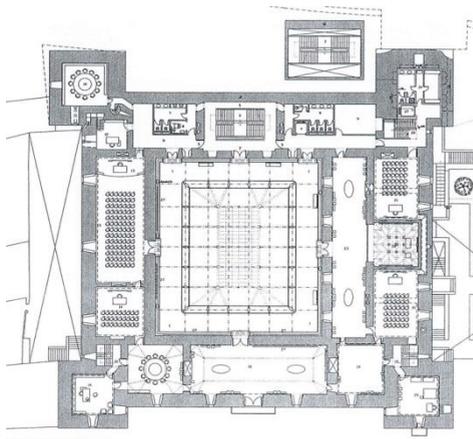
Plano de planta baja del estado reformado (James Manson, 2005)
